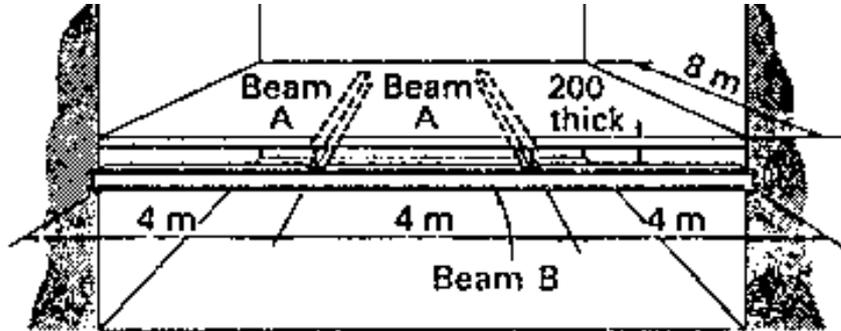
Vigas Secundárias descarregando sobre Viga Principal. (Seward, 1998).
